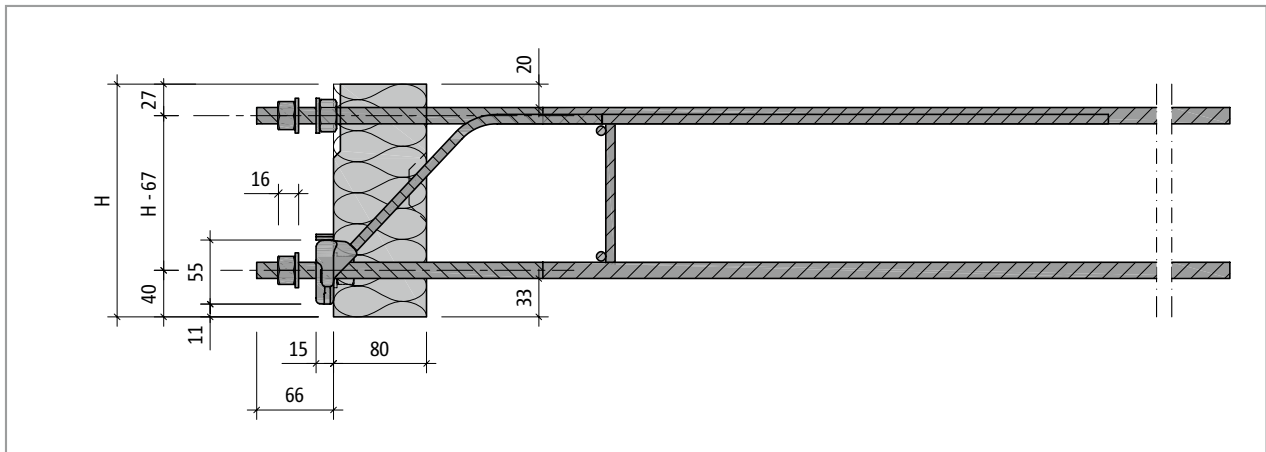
Schöck Isokorb® T type SK-MM1-VV1: Cross section of the product
